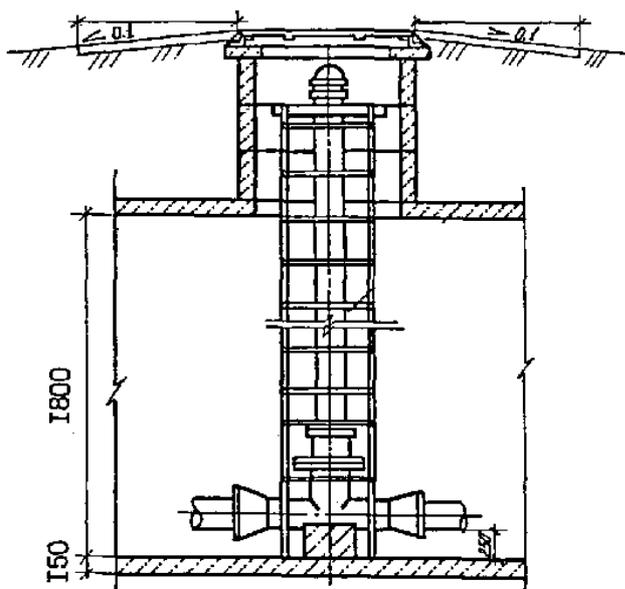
Схема установки пожарного гидранта на водопроводной сети
